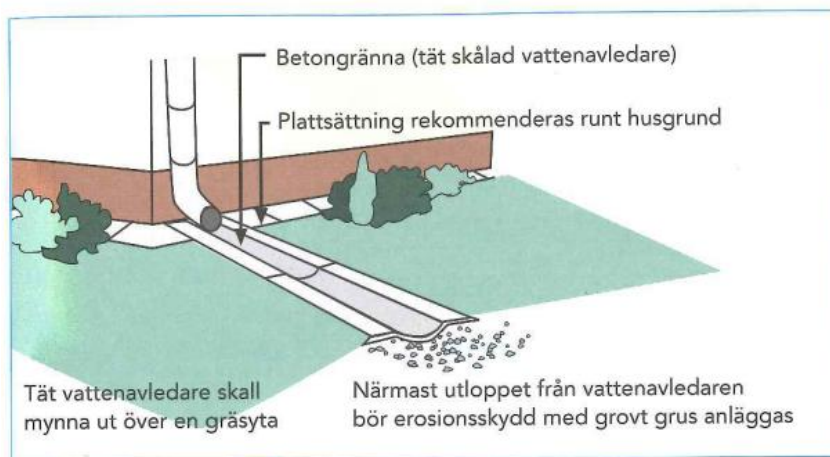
Planskiss på stuprörsutkastare med tät vattenavledare (källa P105).
